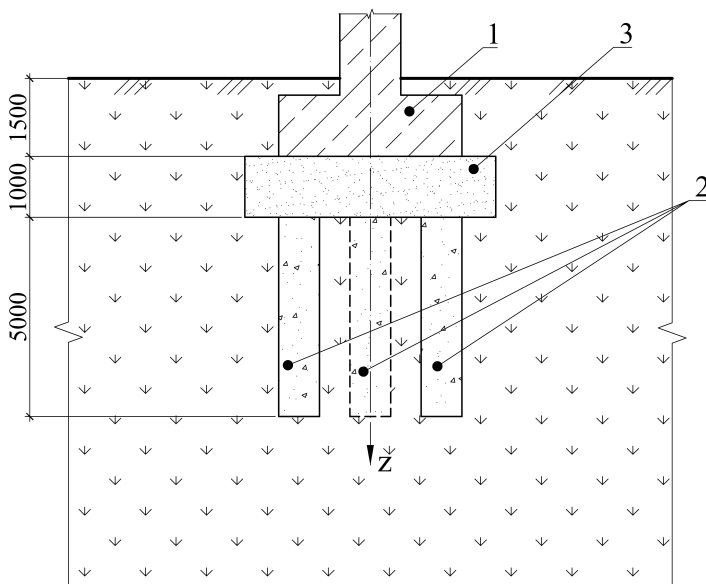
Расчетная схема упрочнения основания жесткими вертикальными армоэлементами из грунтовых свай:
